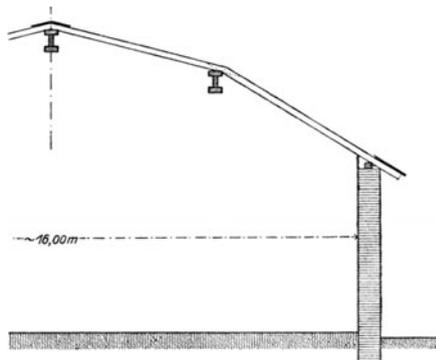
Gebäudequerschnitt. Dachwerk mit Trägerrahmen.
